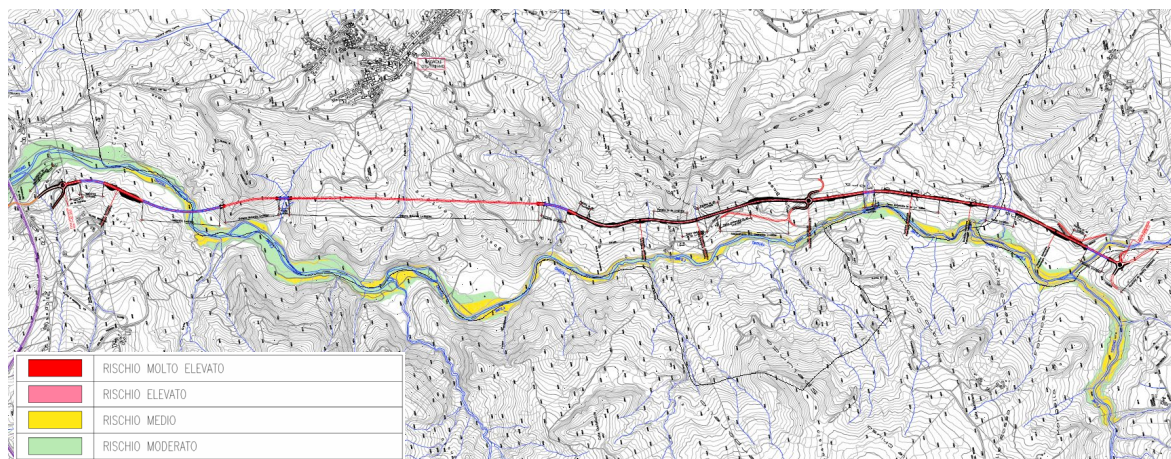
B – Estratto PsAI “aree a rischio alluvioni” con localizzazione tracciato stradale di progetto
